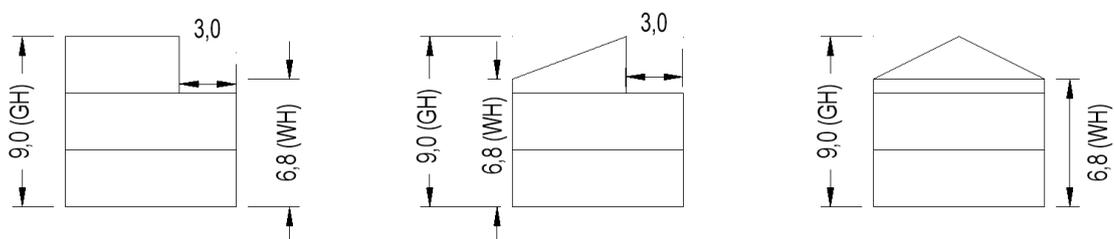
Schematische Darstellung Gebäudehöhen, o. M.
